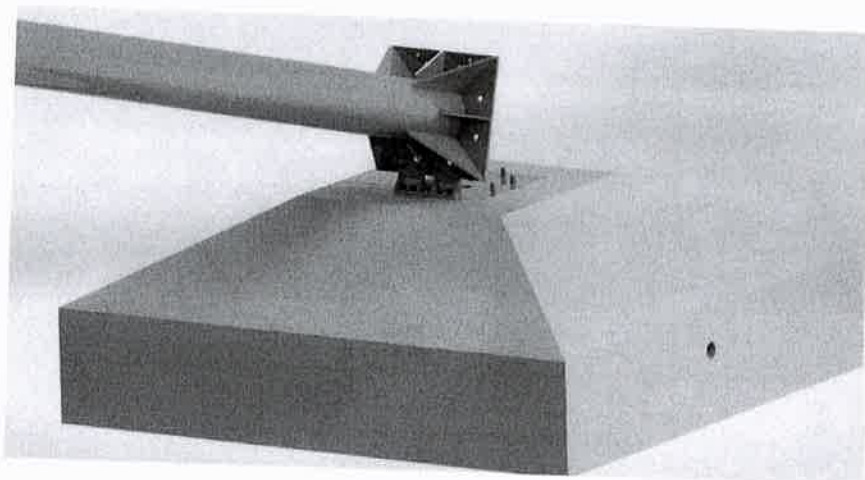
La bisagra conecta la plancha de la cimentación con la plancha de la base del poste
